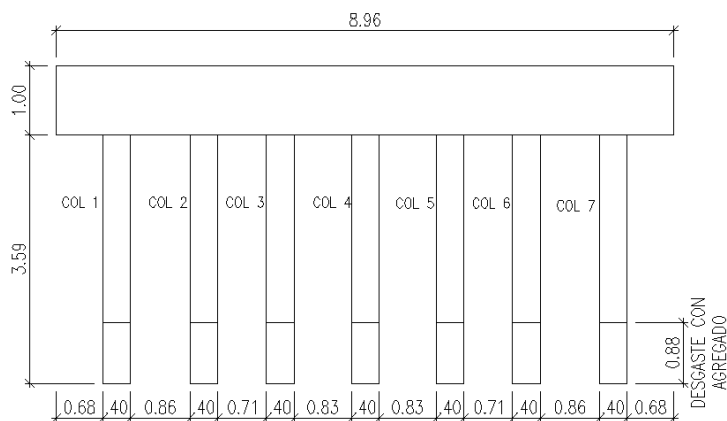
Alzado viga cabezal eje P7. Fuente: Propia
